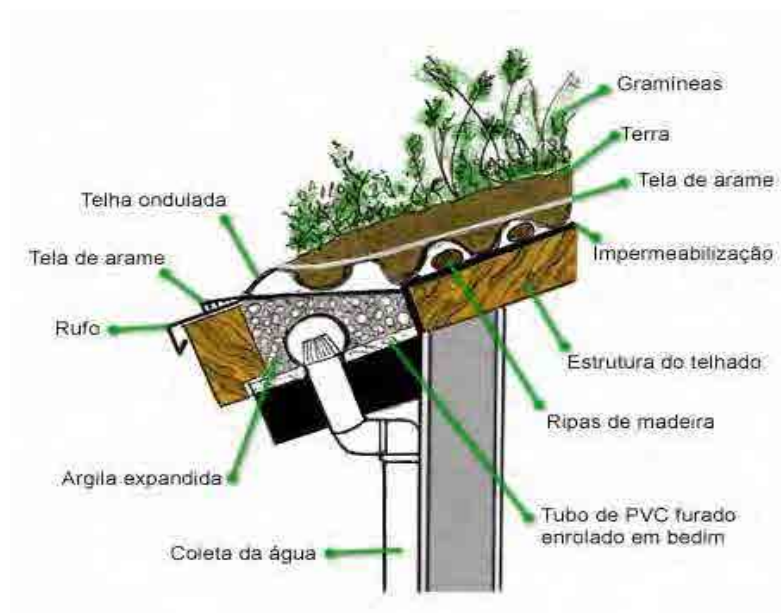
Detalhamento arquitetônico do sistema de cobertura verde inclinada.
